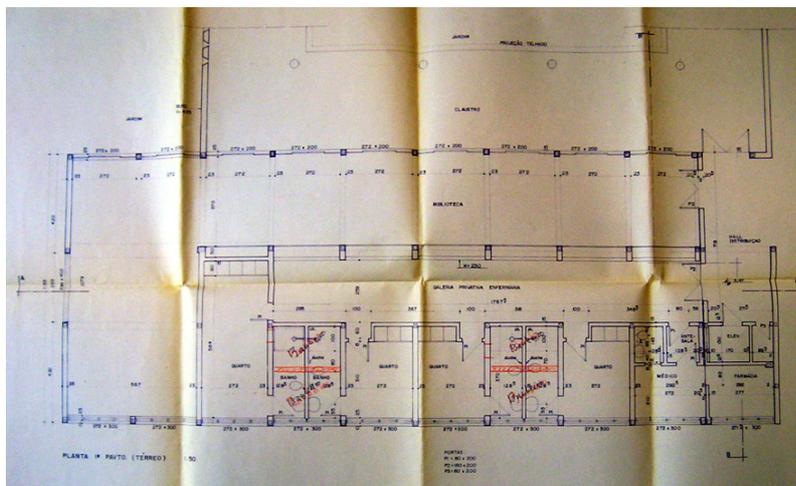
Planta do Primeiro Pavimento do Bloco 5: Enfermaria e Biblioteca. Projeto executivo, junho de 1993. (Fonte: MNSG).
